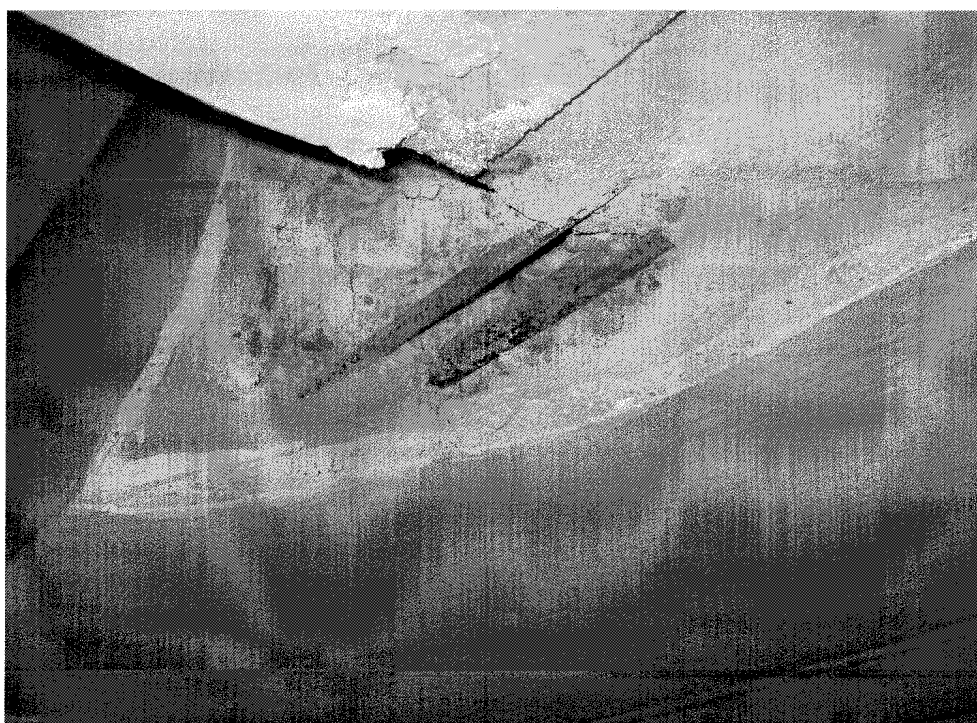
Architrave in c.a. per trave a piano Secondo (copertura piano Primo)
